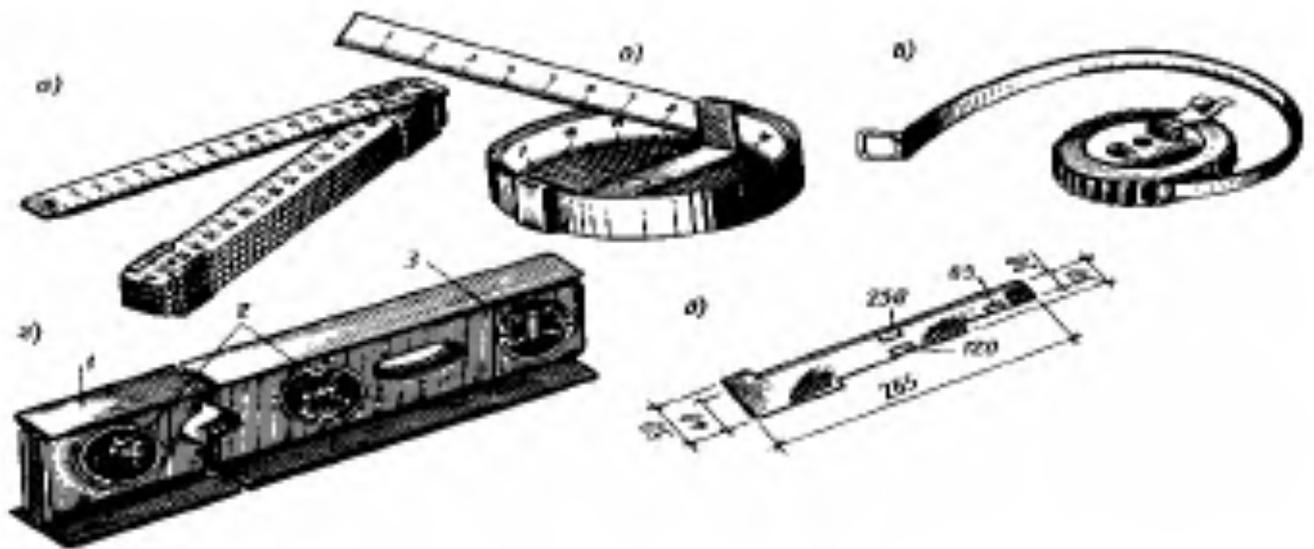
Контрольно-вимірювальний інструмент:
